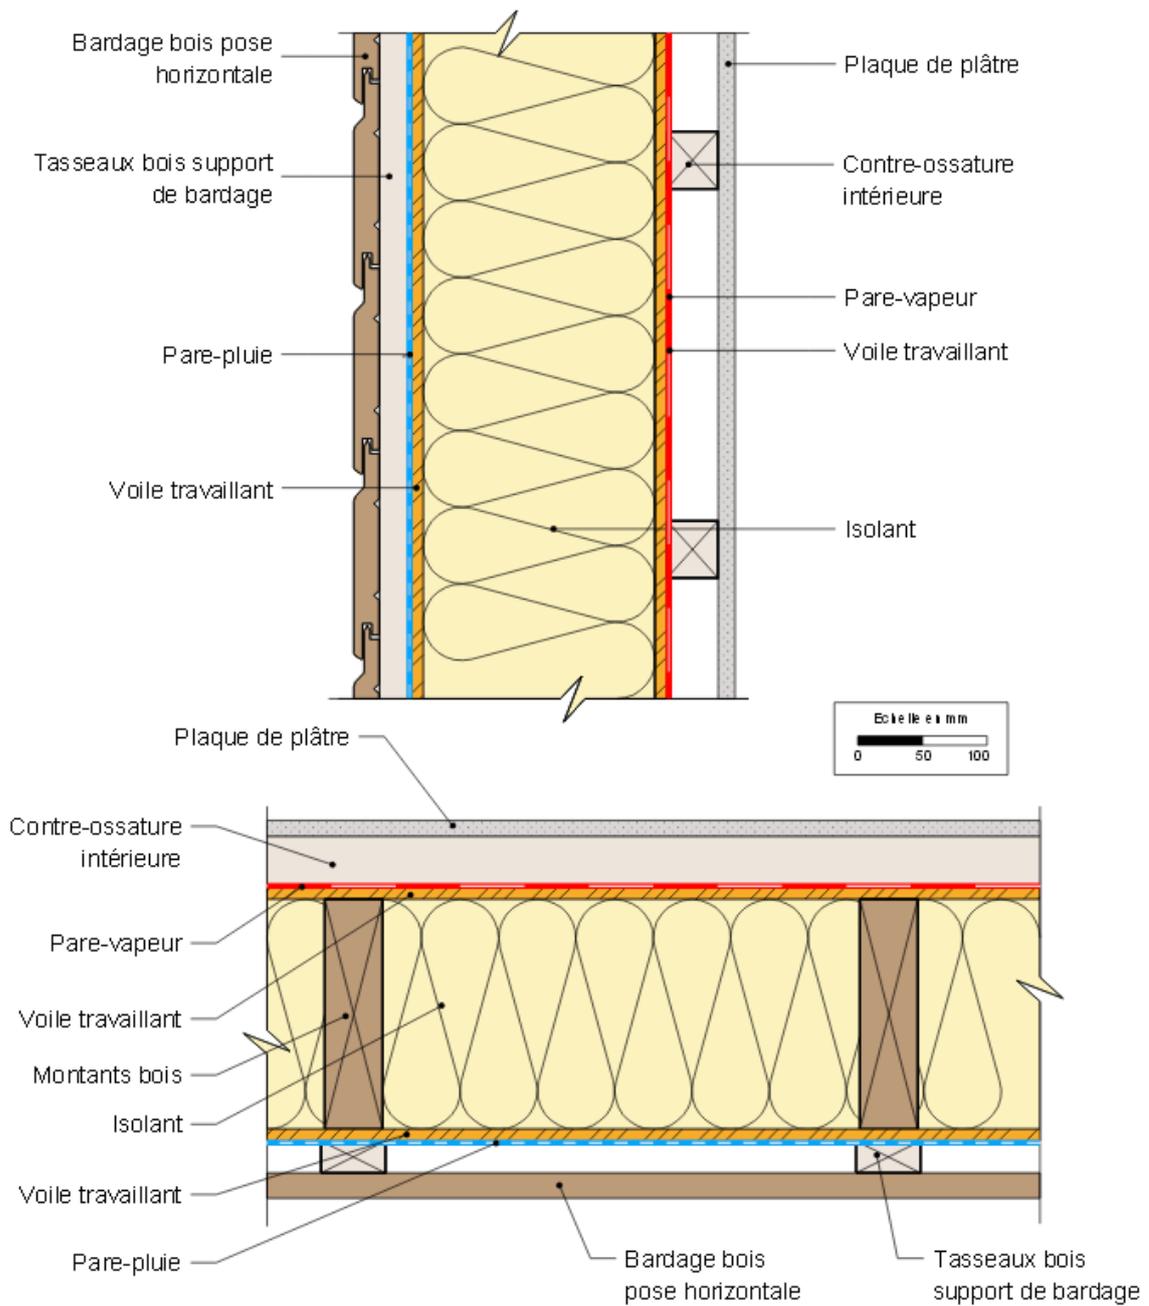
Contreventement sur les deux faces (coupe verticale en haut, verticale en bas)
